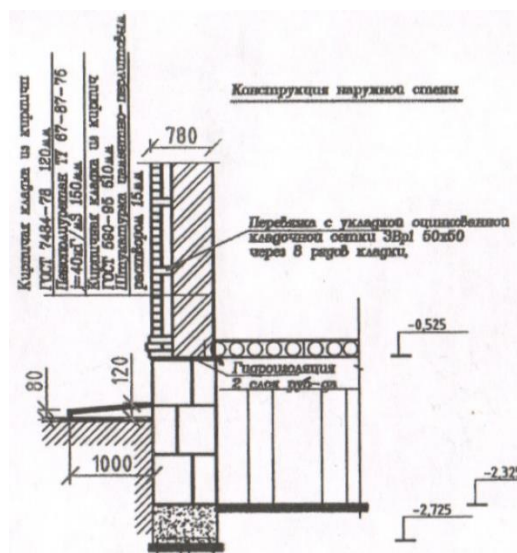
Конструкция наружных стен зданий по ул. Магистральная.
